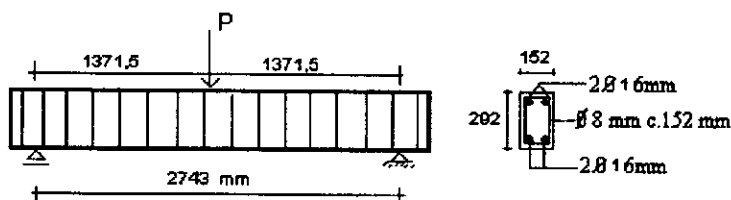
13 – Características geométricas e detalhamento das 14 vigas ensaiadas por GRACE et al.
